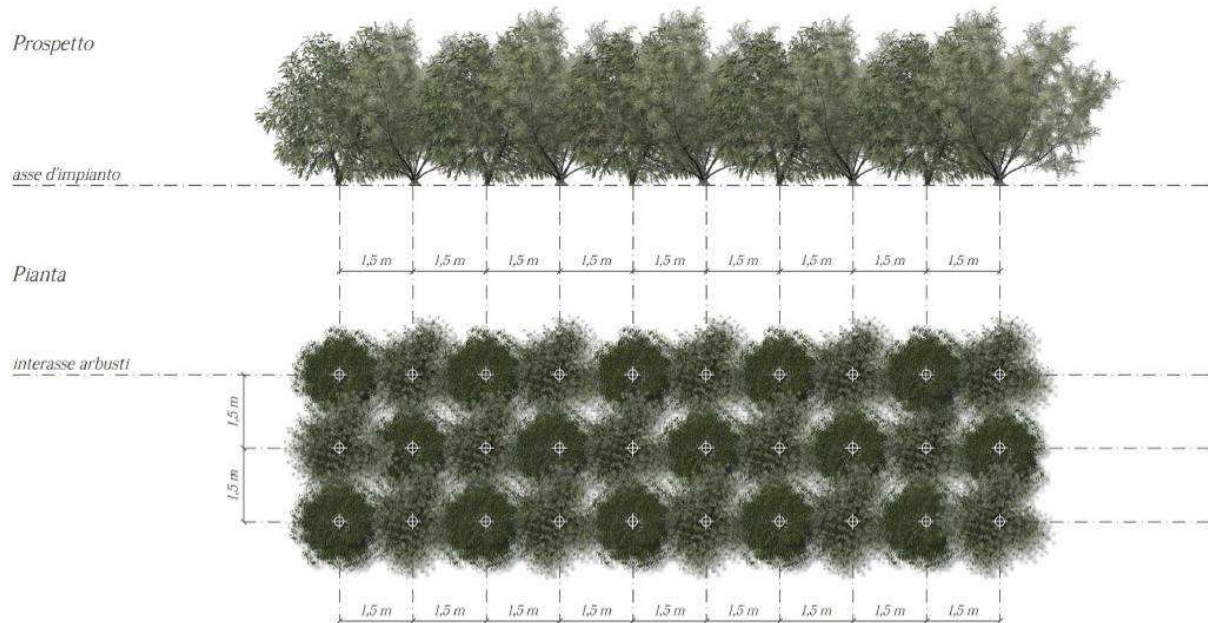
TIPOLOGIA B – PROSPETTO E PIANTA
